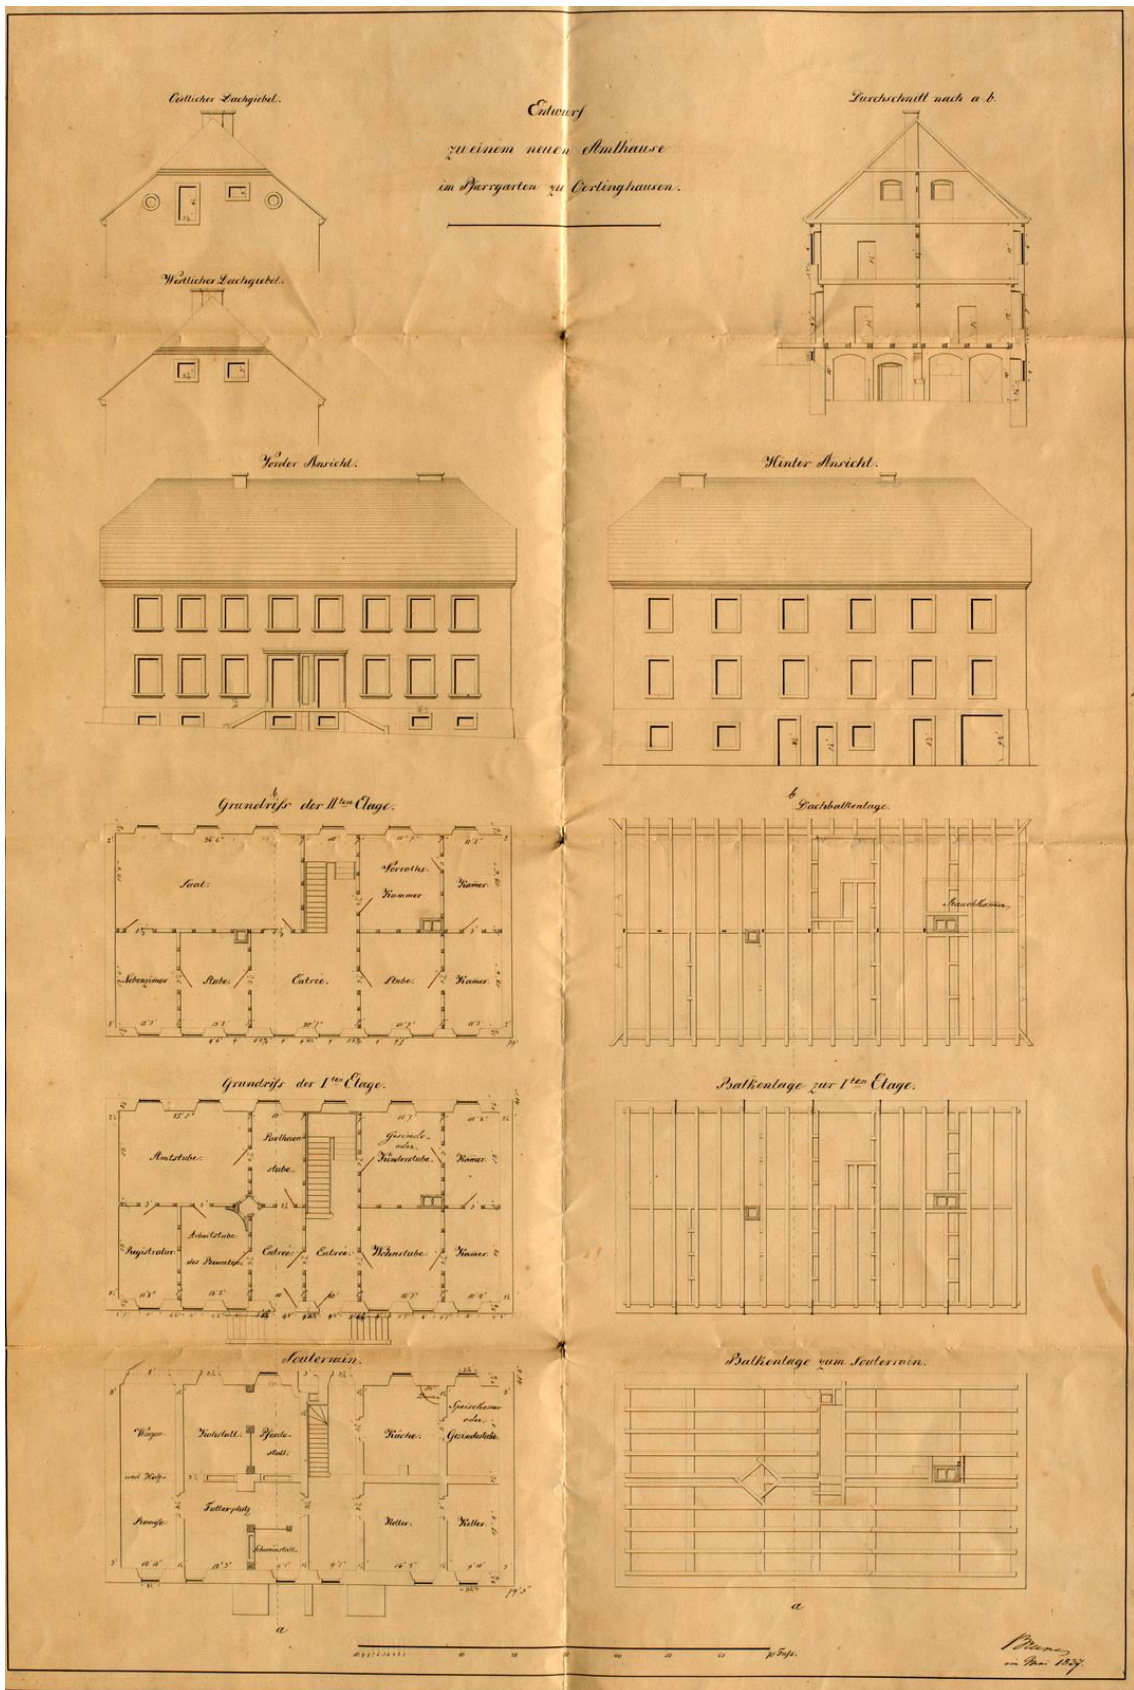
Entwurf zu einem neuen Amthause im Pfarrgarten zu Oerlinghausen, Ferdinand Brune, 1837. Ansichten, Querschnitt, Grundrisse und Balkenlagen. (LAV NRW OWL, L 92 R, Nr. 1535)
